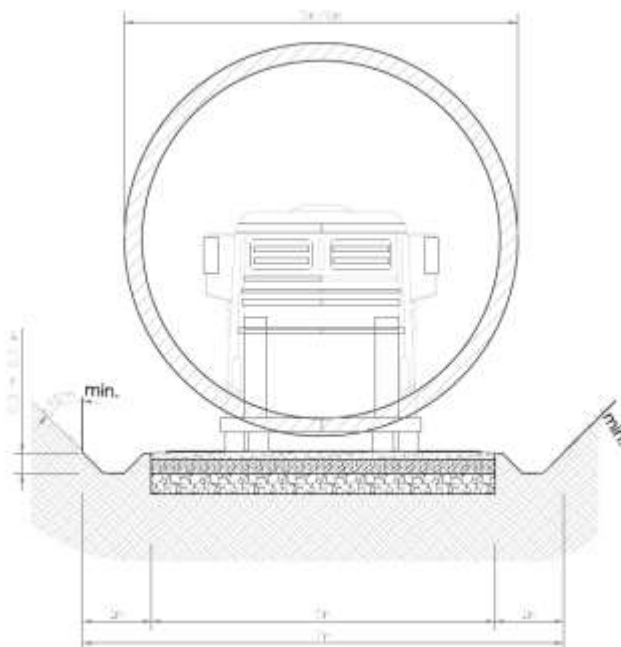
Sezione stradale tipo con rappresentazione dell'ingombro trasporto
